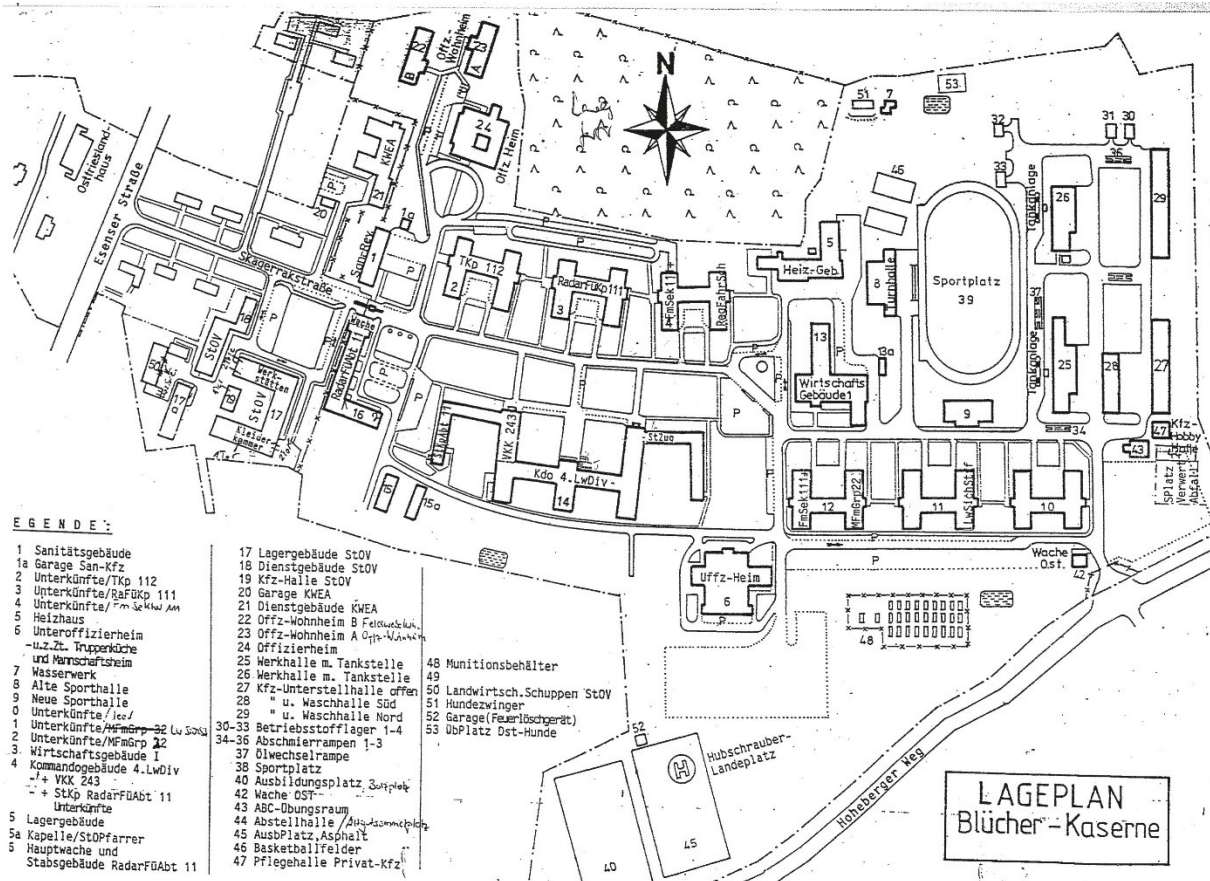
Gebäudeübersicht Lageplan Blücher-Kaserne
